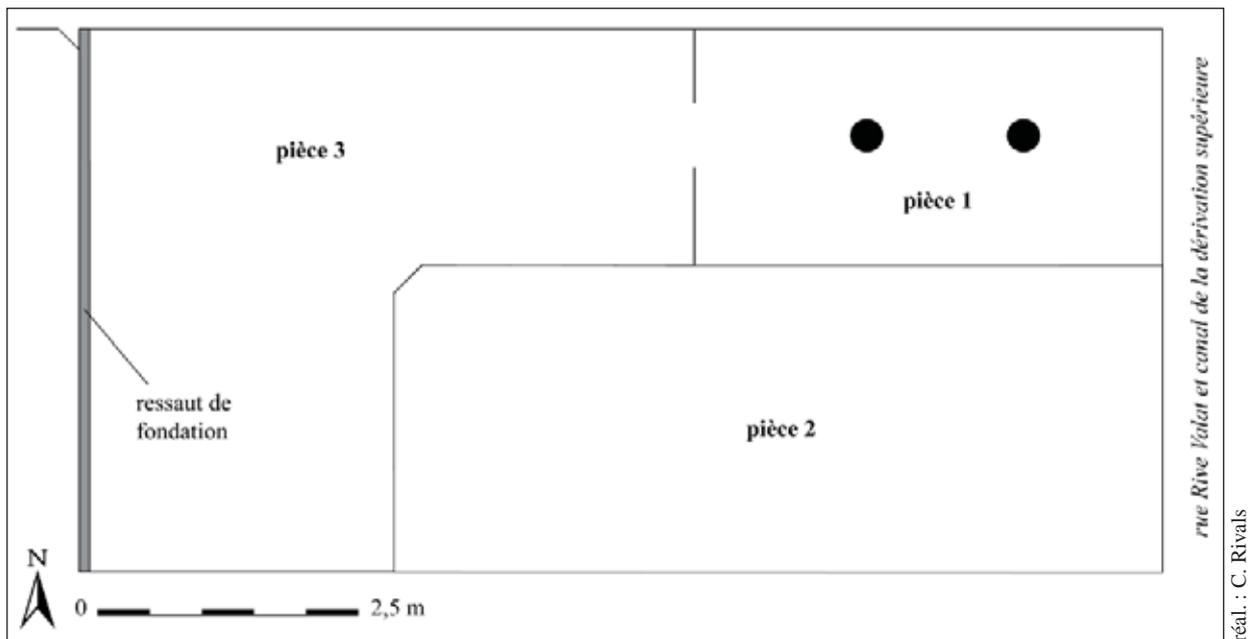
croquis à l'échelle du rez-de-chaussée
